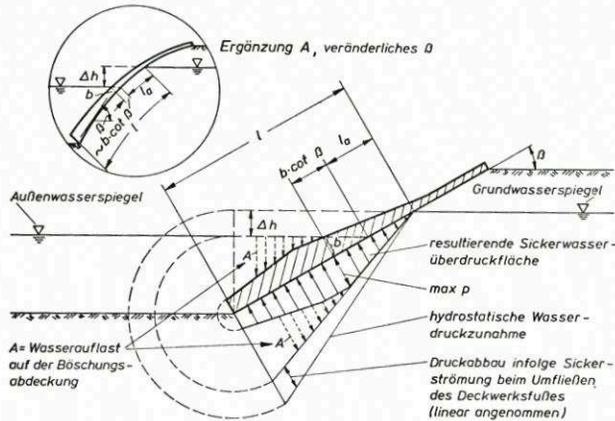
Erläuterungsskizze zur Standsicherheitsuntersuchung einer dichten Böschungsabdeckung
